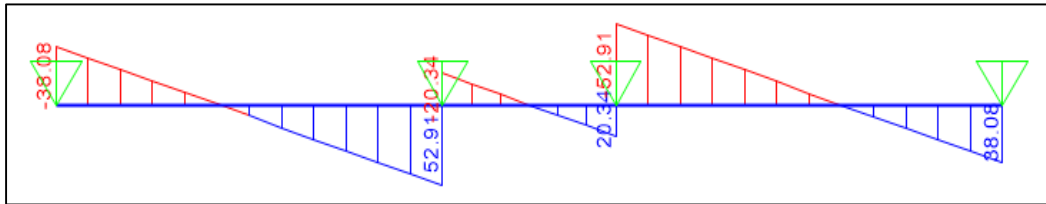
DFC de la viga - Zapata reticular con viga de cimentación - Sistema aporticado
